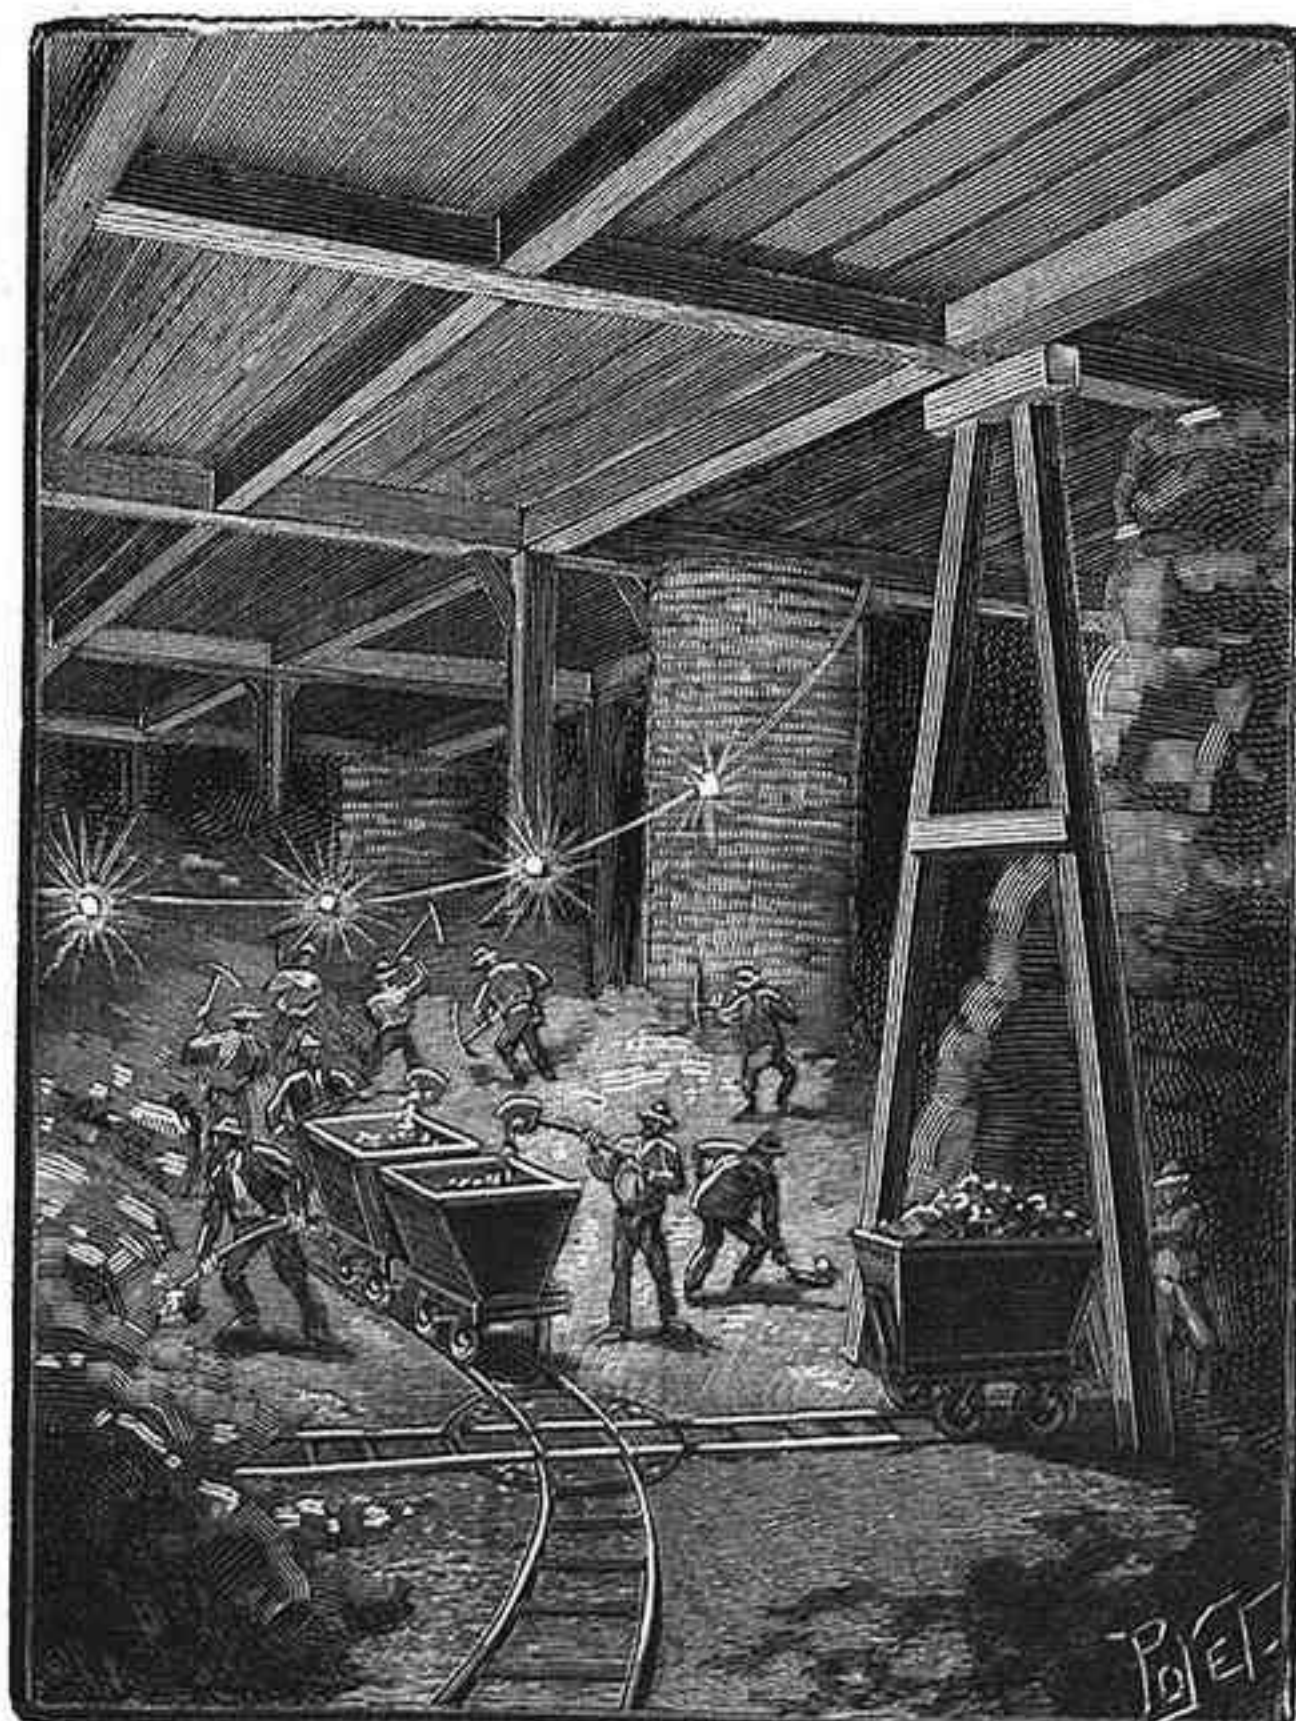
Extracción de tierras alrededor de las pilas de cemento armado
